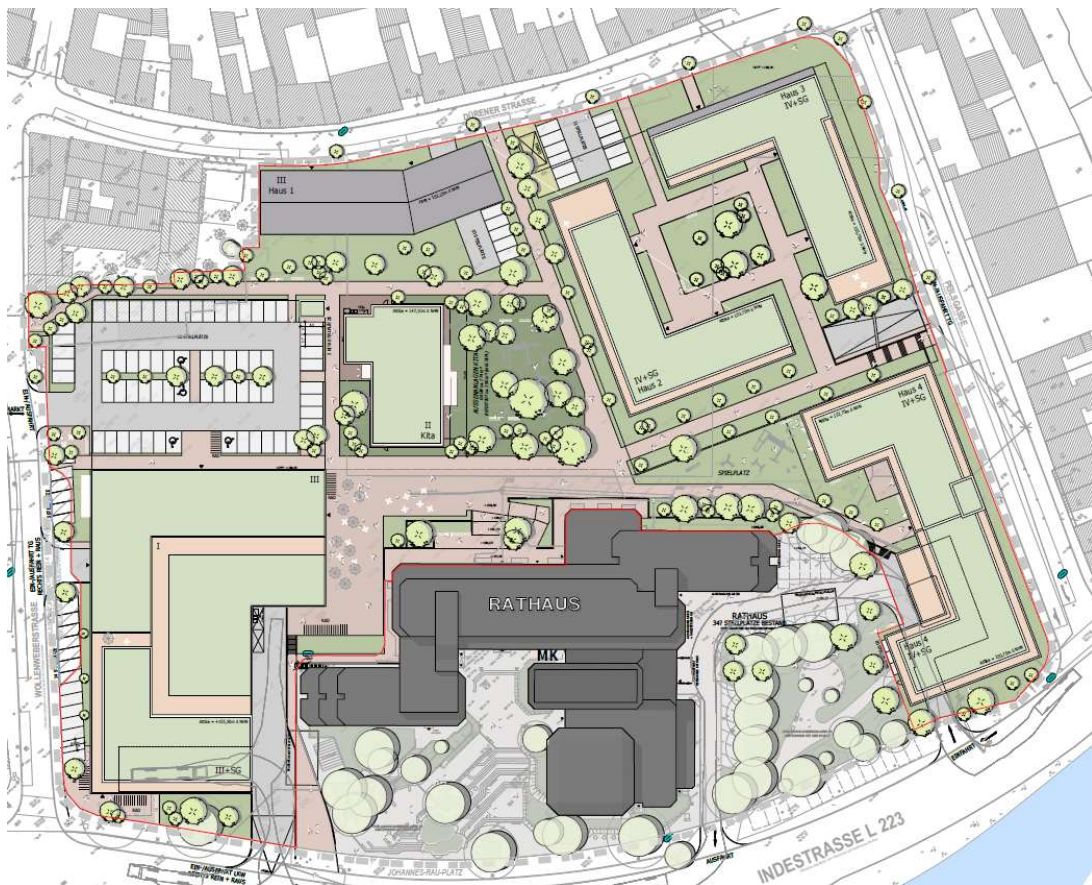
Lageplan des Projektes, Stand November 2022 [Quelle: Ten Brinke Gruppe], ohne Maßstab
